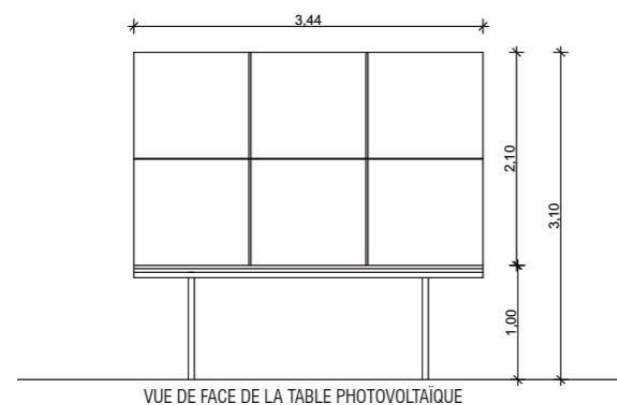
Vue de face d'une grande table photovoltaïque (6 panneaux) sur pieux battus
